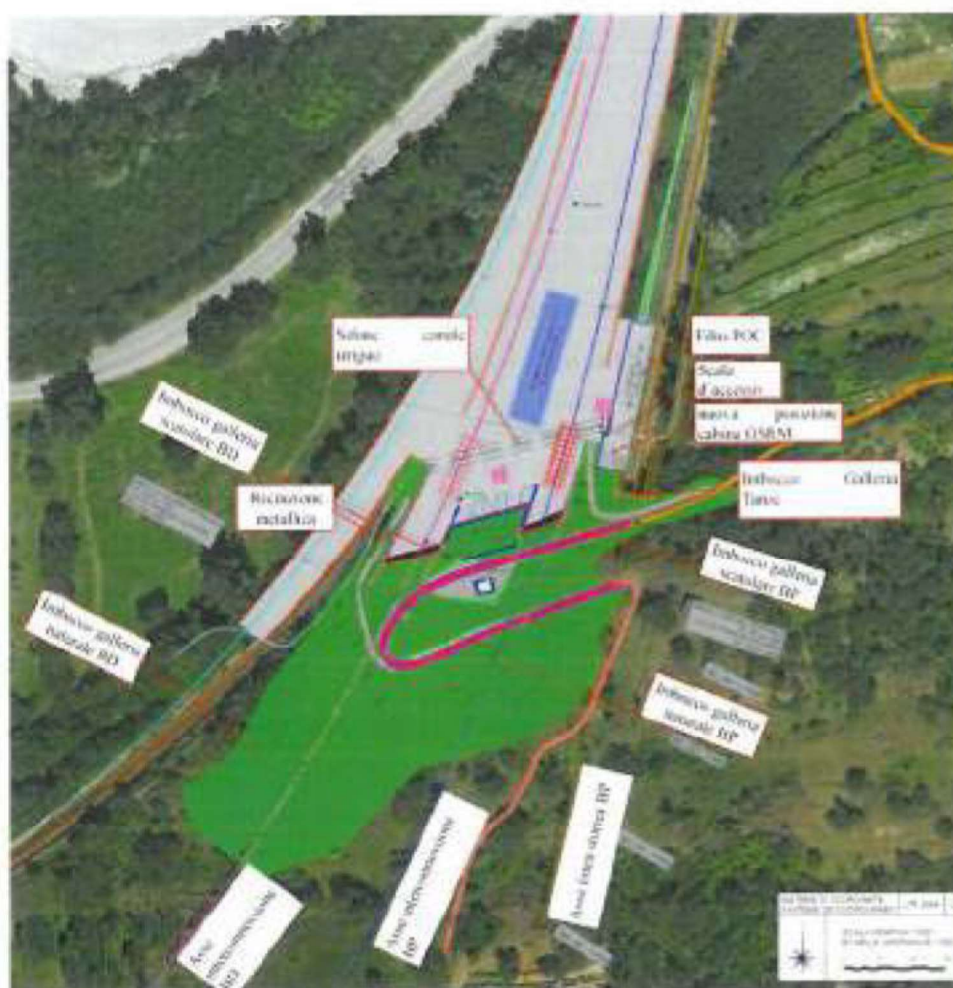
Planimetria Imbocco Est Tunnel di Interconnessione
